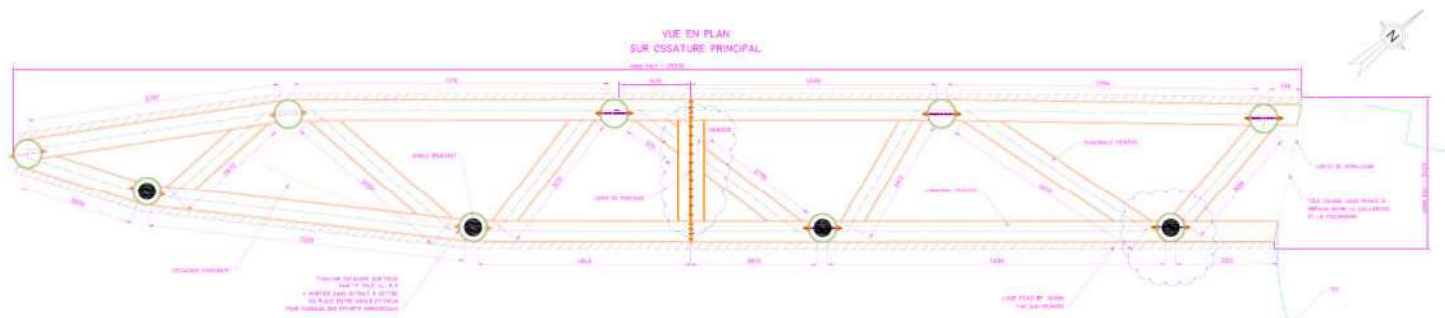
Vue en plan de la structure de l'estacade (DOE travaux 2021-2022)
